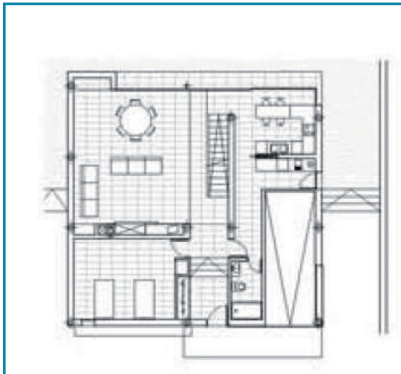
Planta baja. Fotografía: cortesía del estudio Elisa Valero.
